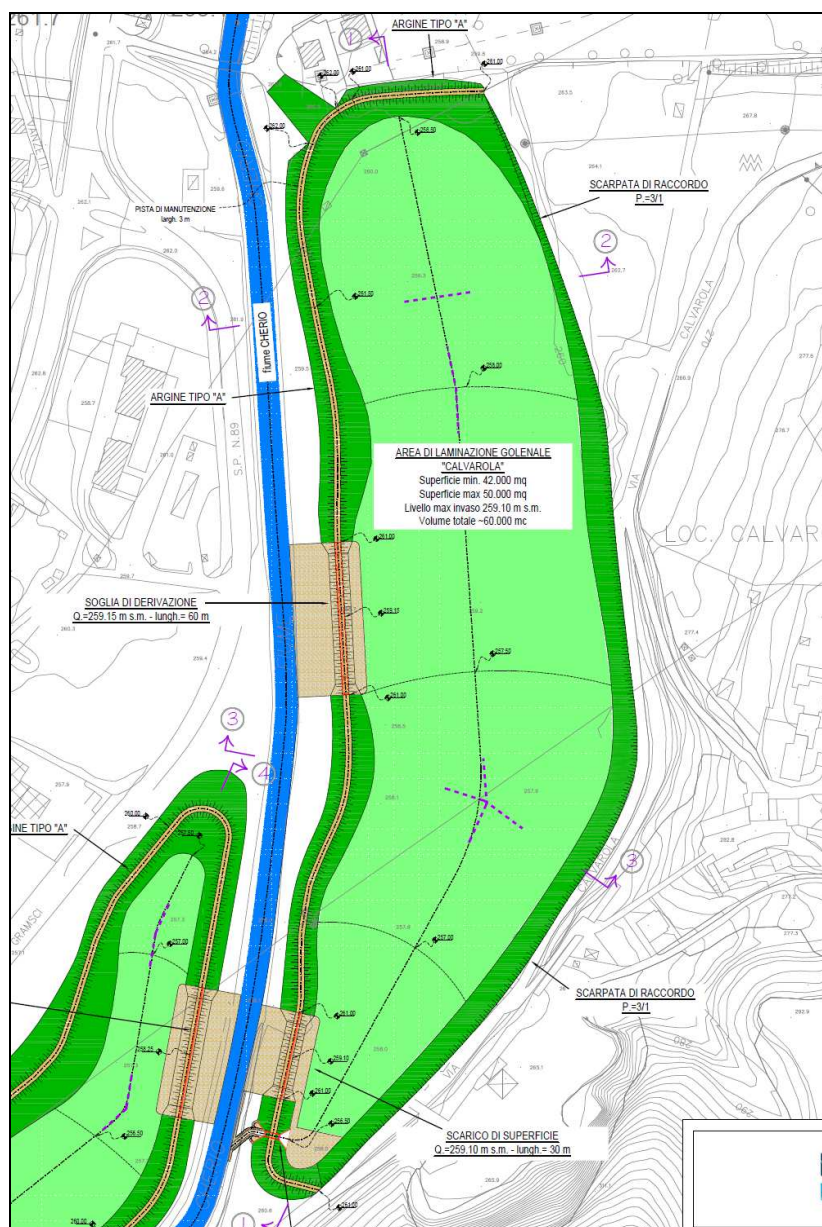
Planimetria dell'area di laminazione golenale "Calvarola"
